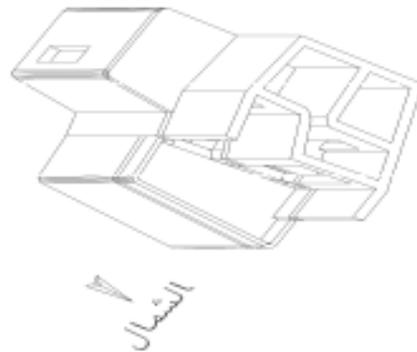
مسقط أفقي للدور الأرضي لدار السندادية عمل الباحث
